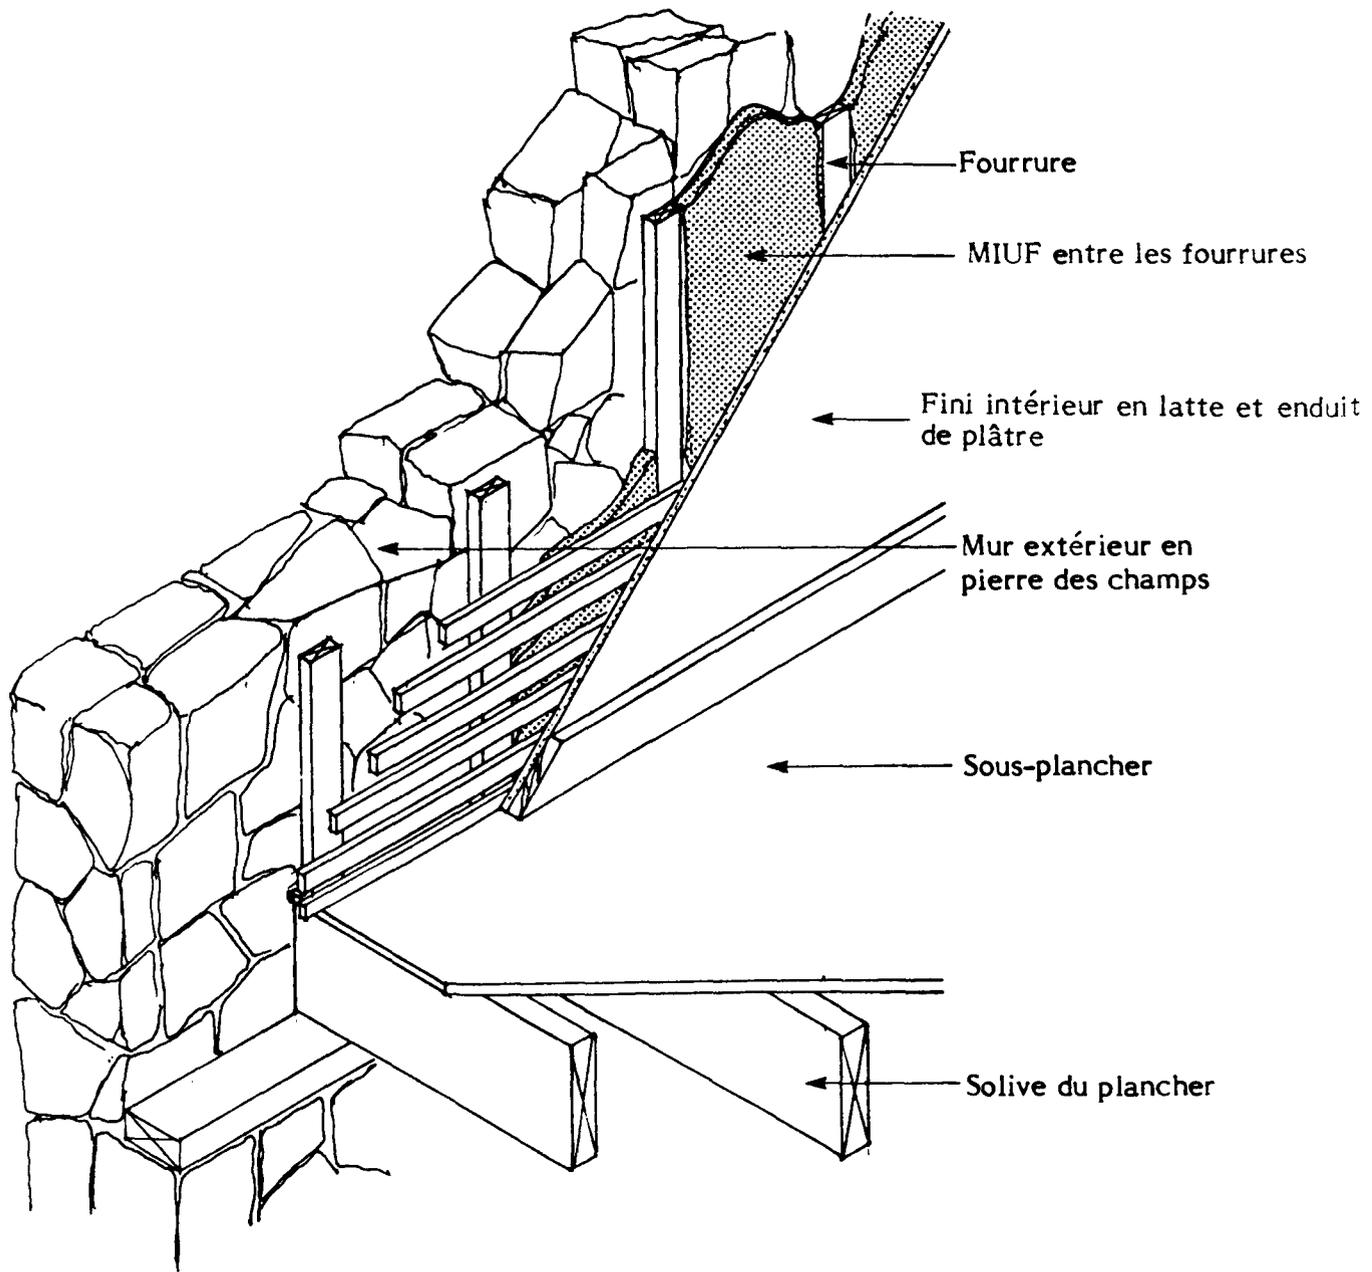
MUR EN PIERRE DES CHAMPS
